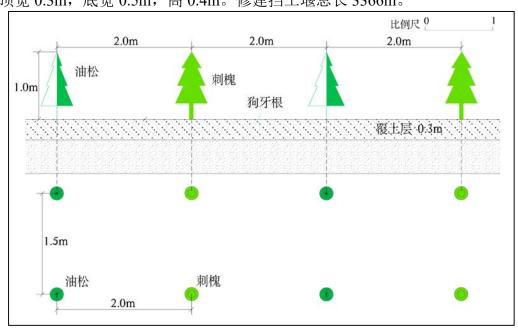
采场平台林地复垦单元工程设计立面图、平面图
